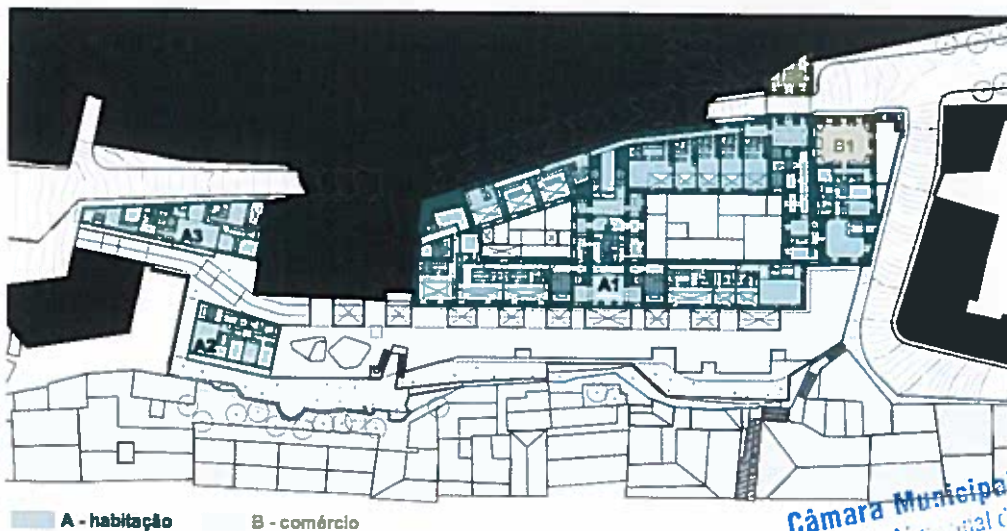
Ocupação possível para a nova construção ao longo da rua do Paraíso.
